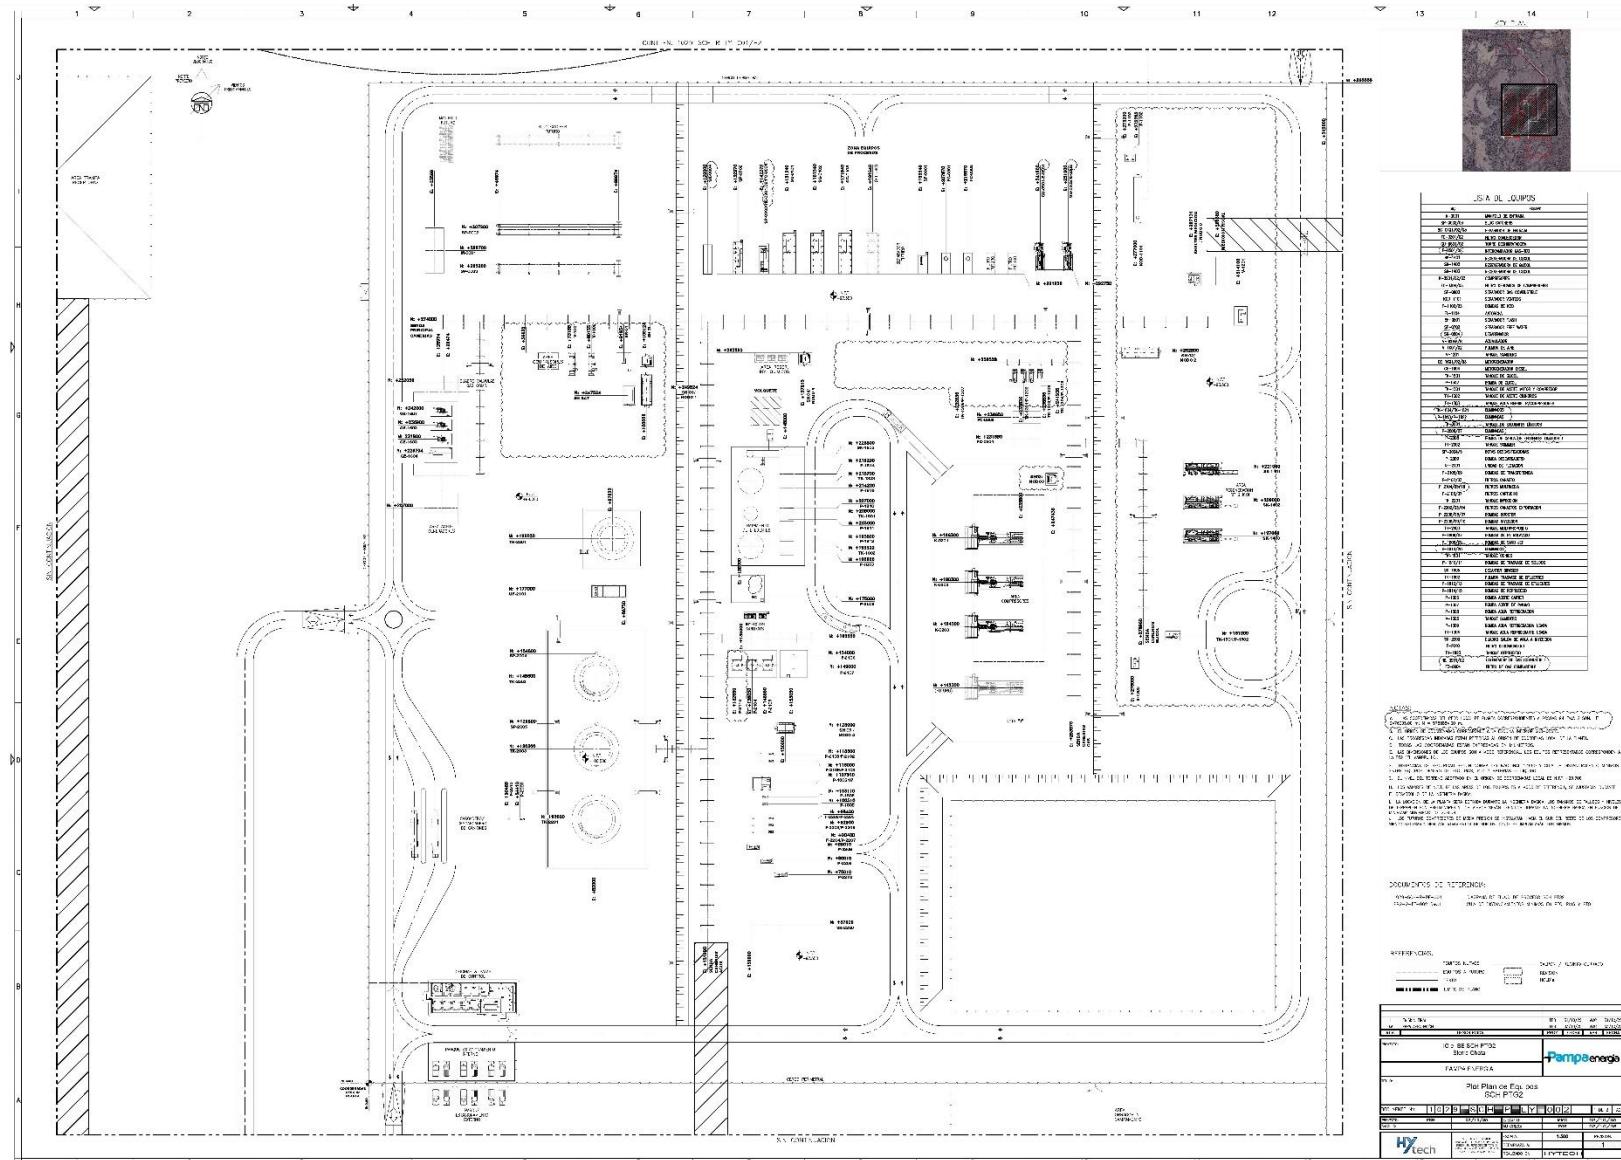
Lay out Plan de equipos en PTG 2 Norte (1/2).
